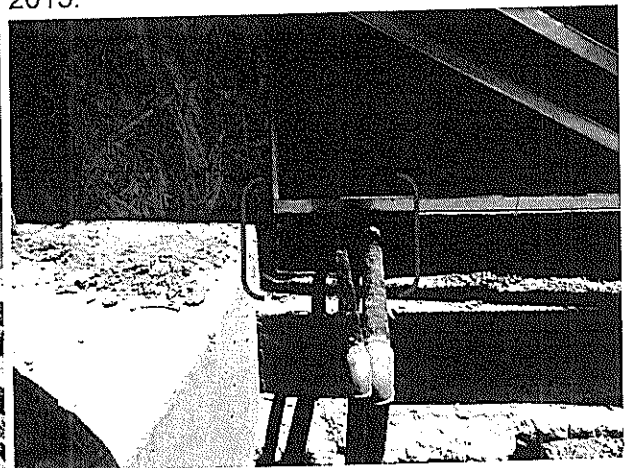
, arista dañada muro hormigón prefabricado edificio A, 17-11-2015.
